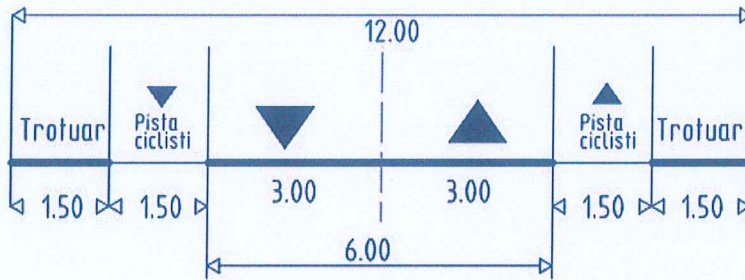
Extras din PUG – profil transversal pentru strada Plevnei, (cat III.4)
